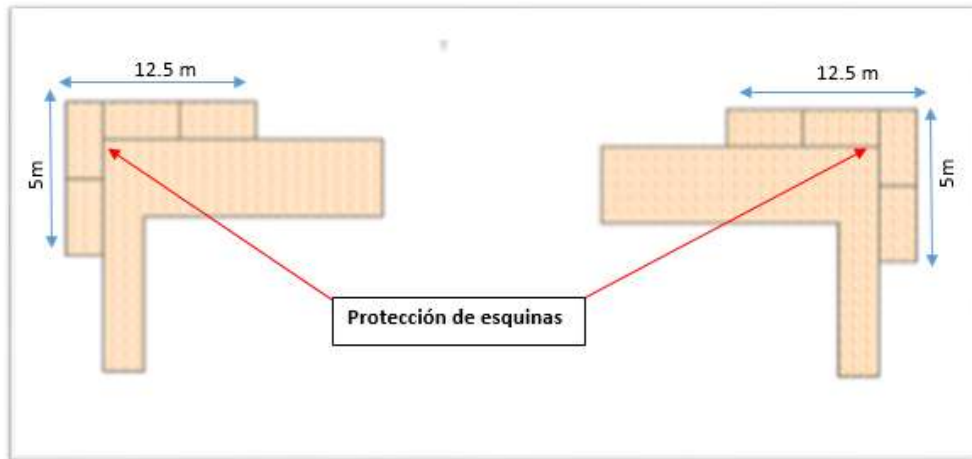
2. Protección de esquinas del local (Vista Planta), Fuente: Elaboración propia.
